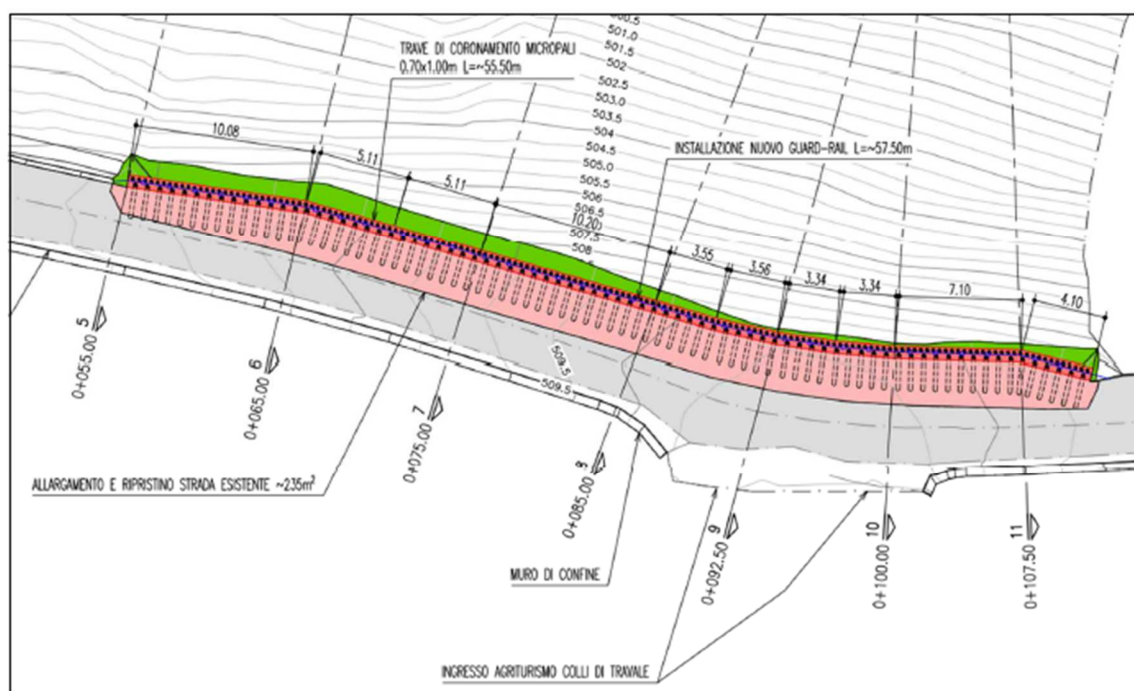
Strada vicinale per Montieri 7 Planimetria dello stato di progetto con individuazione dell'area di intervento presso Agriturismo Colli di Travale
